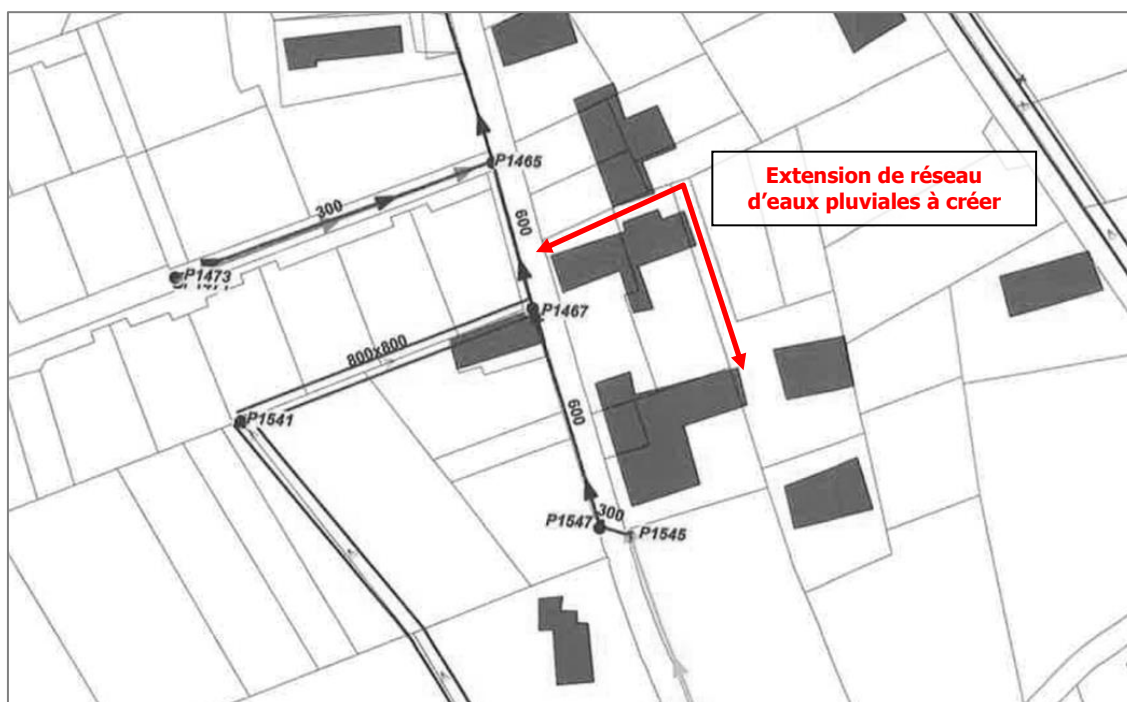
Extrait plan des réseaux d'eaux pluviales – SIEE 2008
